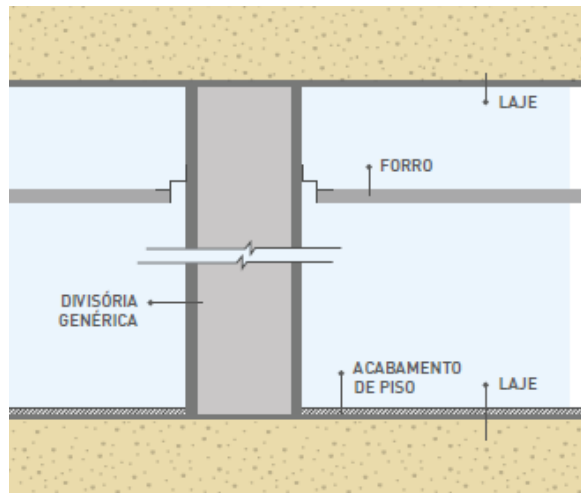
Exemplo Genérico da Divisória Laje a Laje
